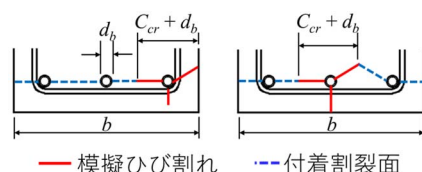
模擬ひび割れを考慮した割裂線長さ
